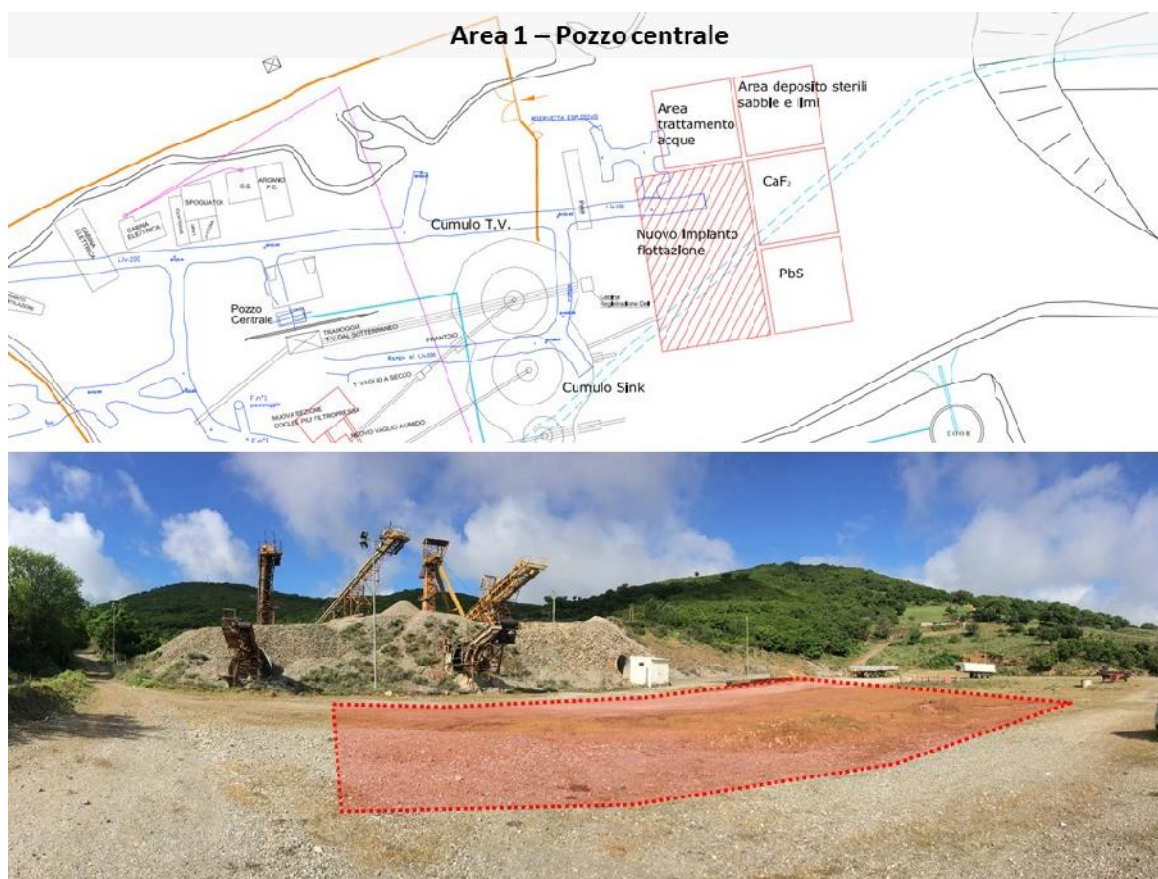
Stralcio della planimetria di progetto e vista della porzione di piazzale in cui verranno realizzate le nuove infrastrutture
